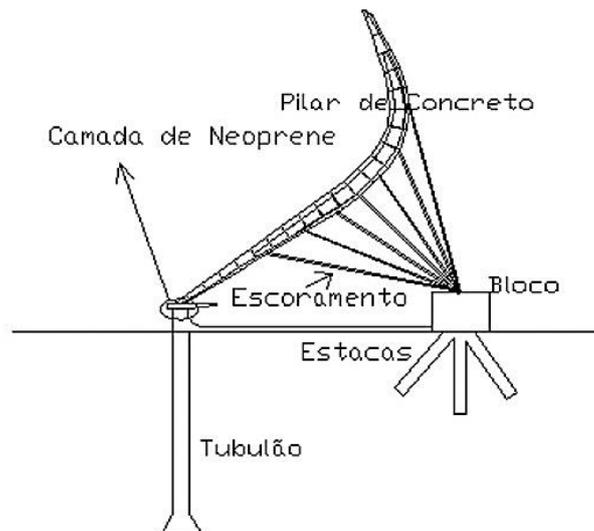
Estrutura de escoramento das colunas da catedral. Fonte: www.vitruvius.com.br/revistas/²³
